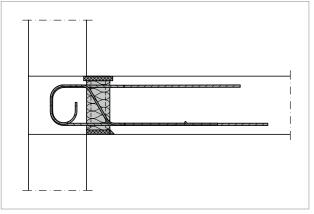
Schöck Rutherma® T type DFi : utilisation entre la dalle et la façade
